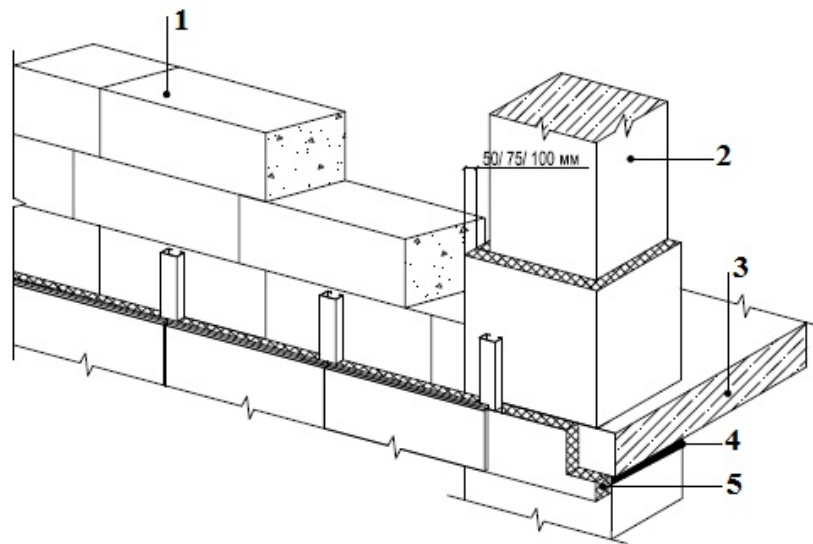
Вариант крепления вентилируемого фасада к стене в каркасном строительстве: 1 — блоки YTONG; 2 — монолитная колонна; 3 — монолитное перекрытие; 4 — заполнение монтажной пеной; 5 — минераловатная плита
